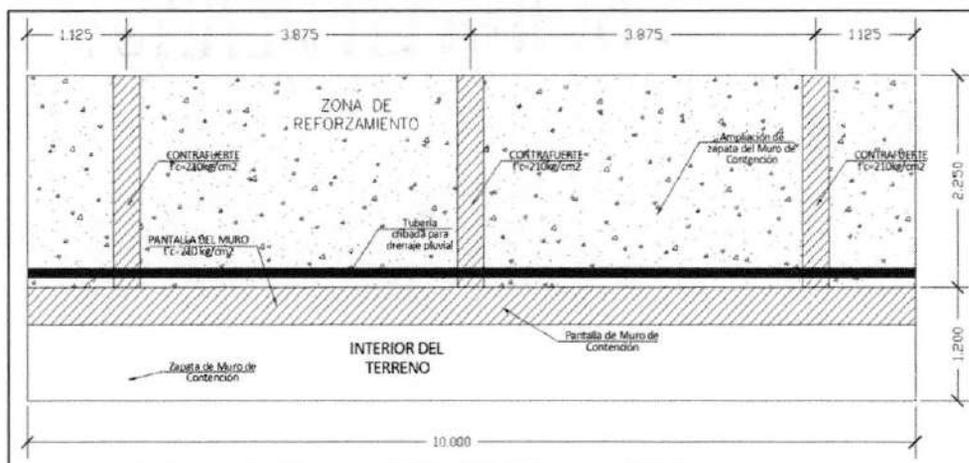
Vista en planta de la propuesta técnica se aprecia la ampliación de la zapata y la inclusión de contrafuertes, el relleno con material granular de préstamo para un paño de muro de contención
